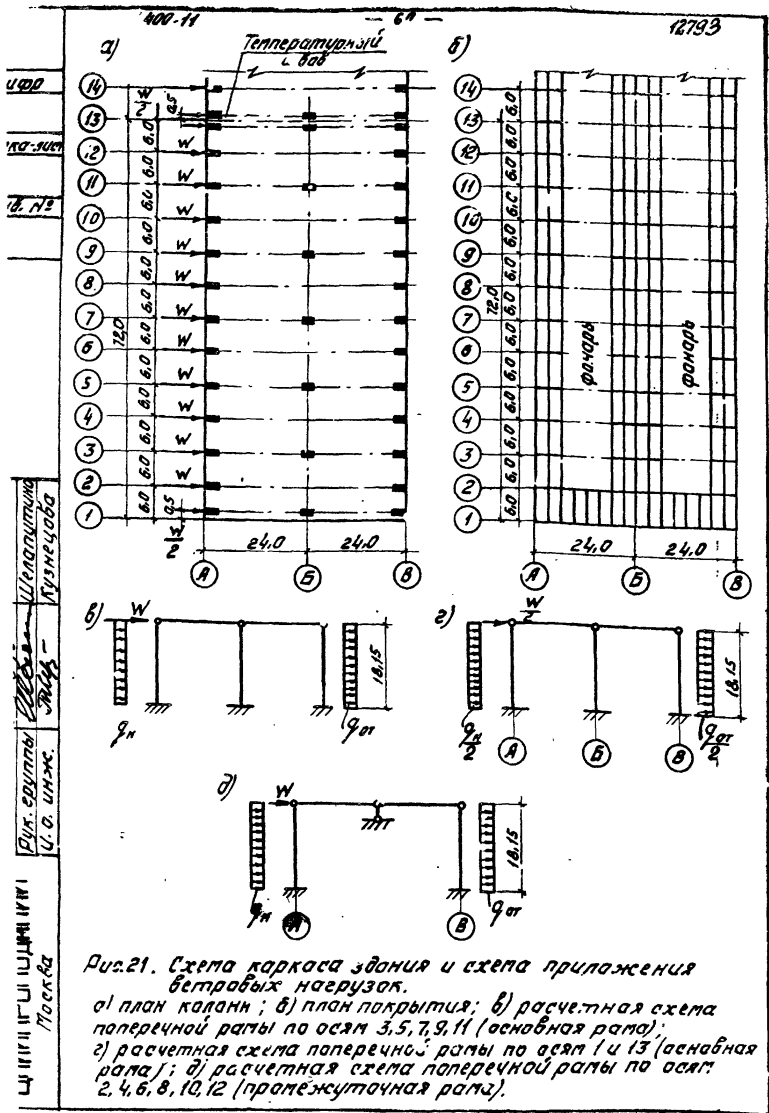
Схема каркаса здания и схема приложения ветровых нагрузок.
